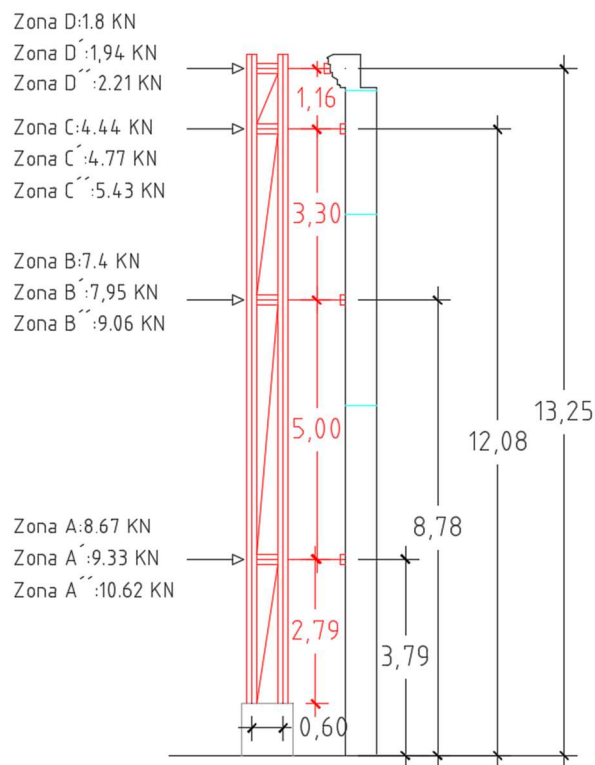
, Esquema de fuerzas aplicadas en la estructura metálica y acotado
